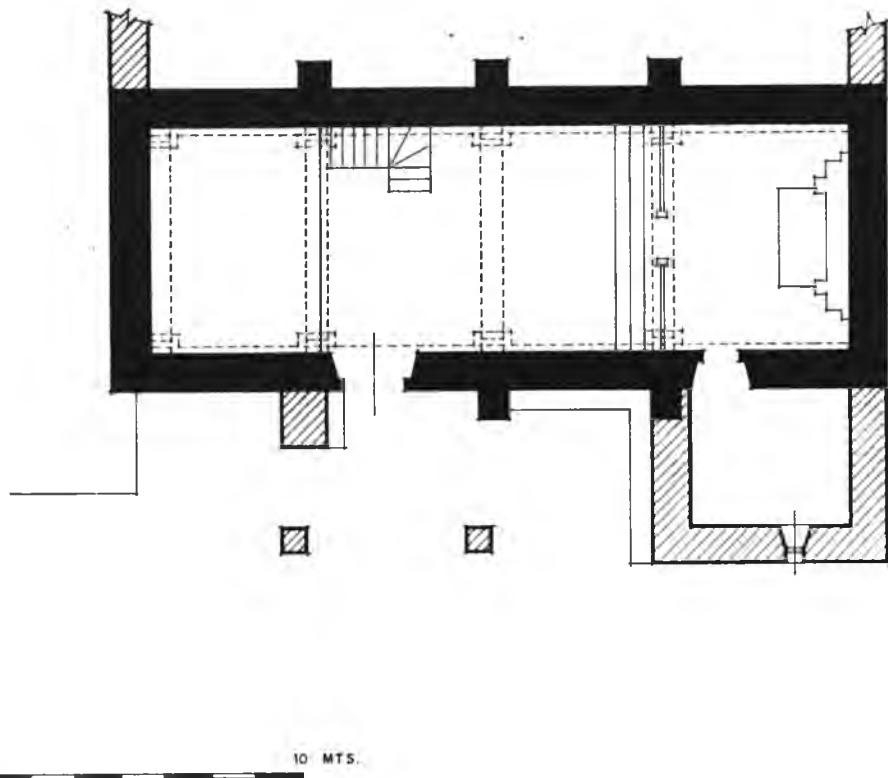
Iglesia parroquial de Olcoz; planta.
